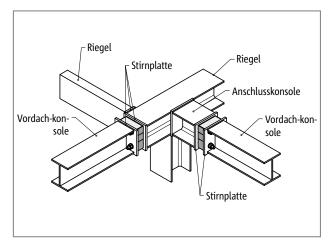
Schöck Isokorb® T Typ S: Außenecke
